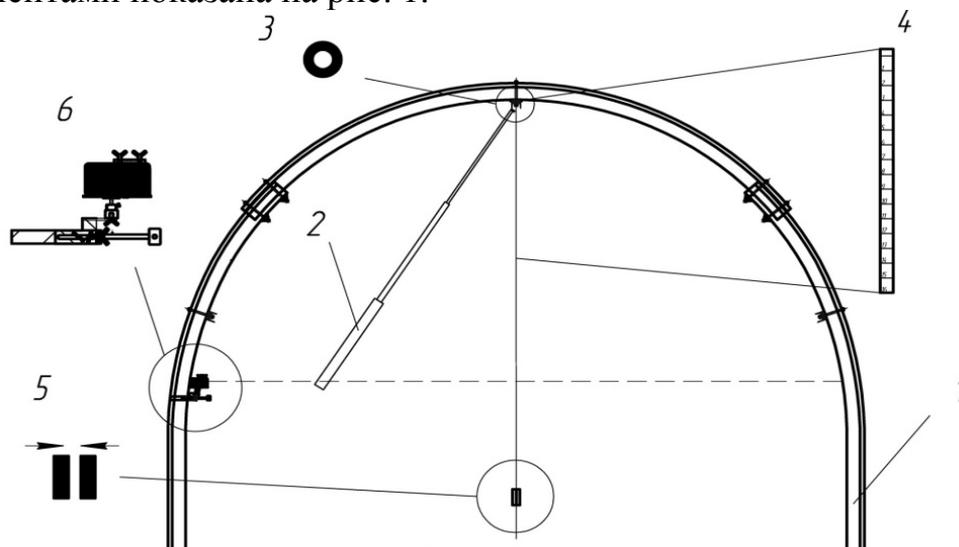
Схема измерительного пункта замерной станции и применяемые инструменты: 1 – металлическая крепь; 2 – телескопический удлинитель для закрепления магнита в верхней точке крепи; 3 – магнит для закрепления ленты рулетки на в верхней точке крепи; 4 – лента рулетки; 5 – магниты-грузы закрепленные на нижней точке ленты рулетки; 6 – измерительное устройство. Конструкция измерительного устройства и схема его закрепления на стойке металлической крепи показана на рис. 2 и 3
